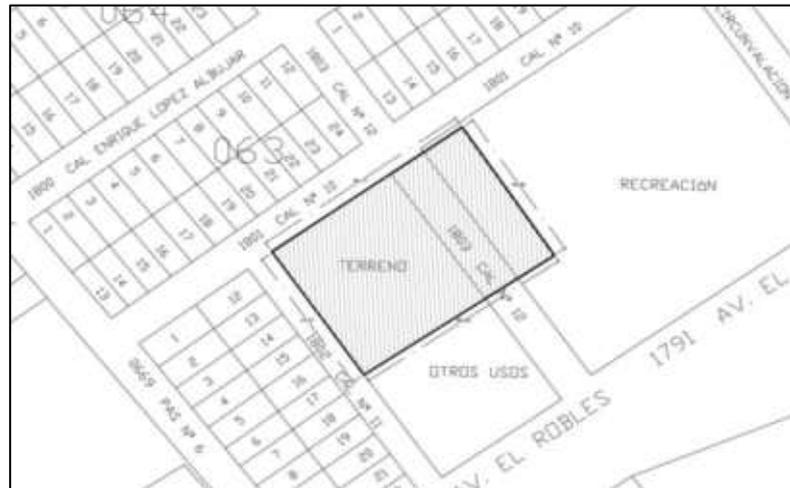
Plano de ubicación del terreno: fuente: elaboración propia.
